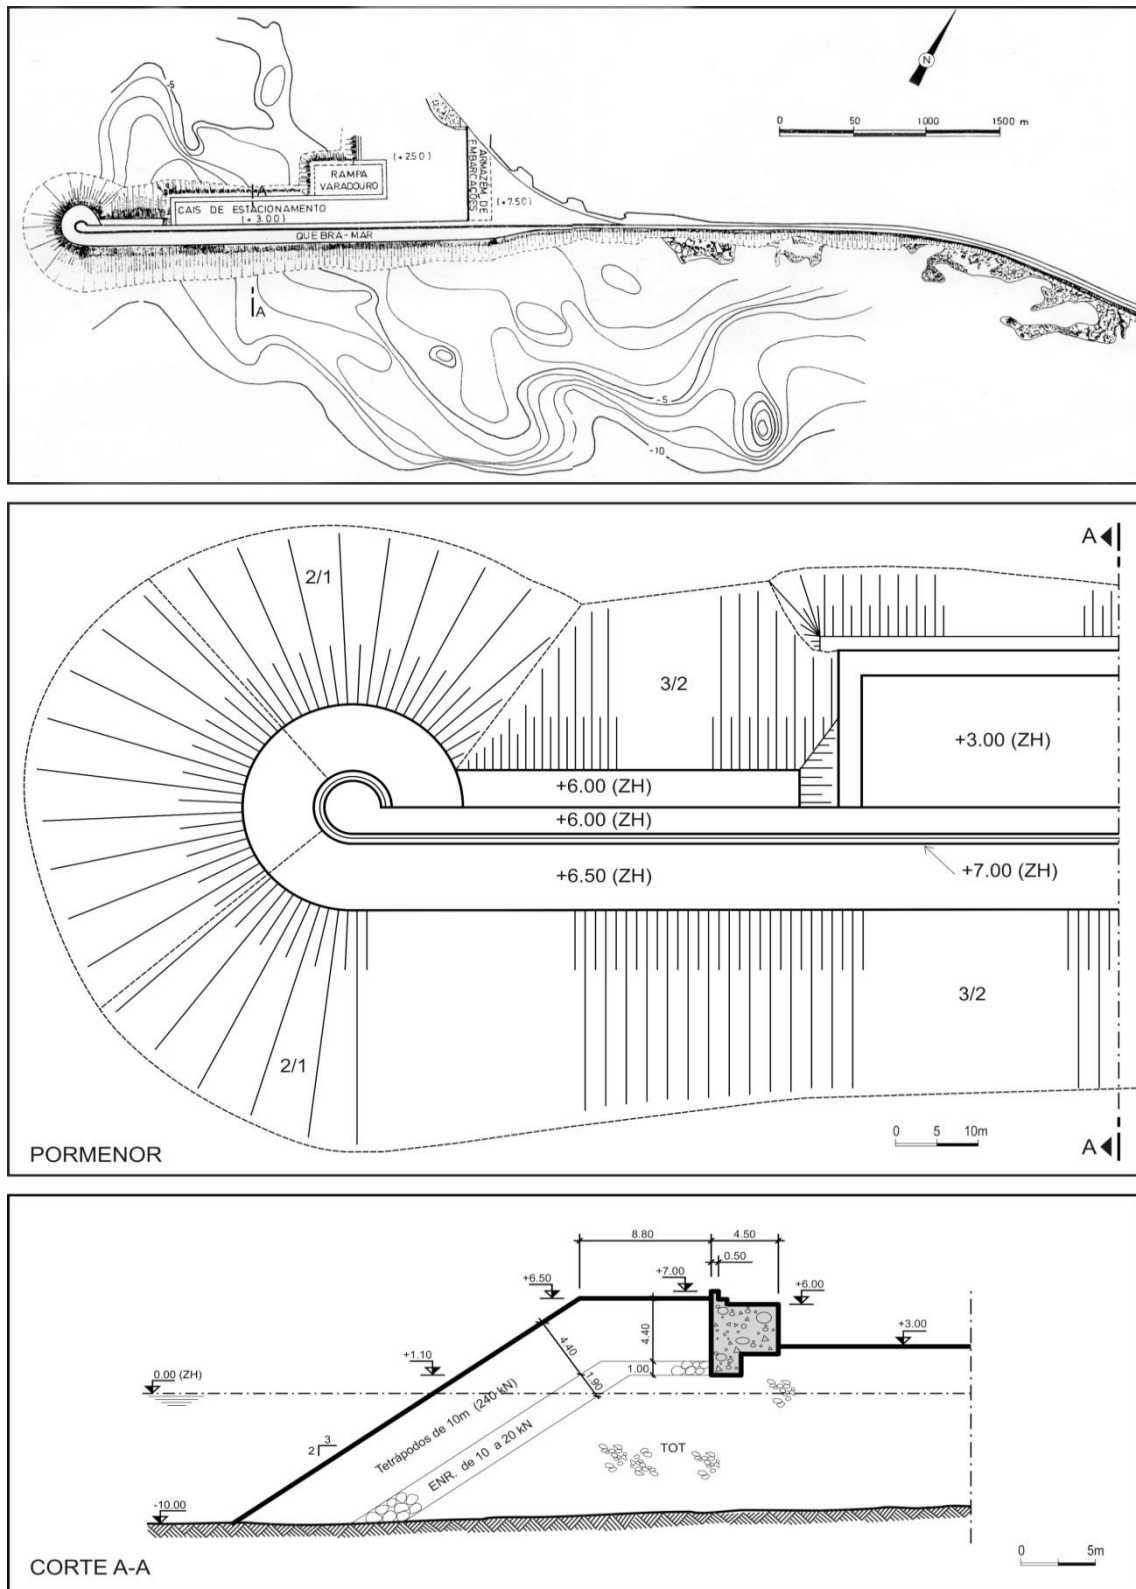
Plantas referentes à marina nascente e respetivo perfil da estrutura de proteção em estudo – ponto D5 (LNEC, 2004).
